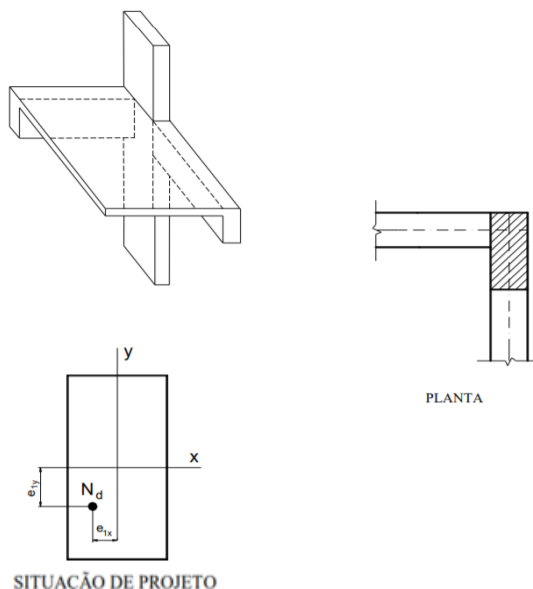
Arranjo estrutural e situação de projeto de pilar de extremidade.
